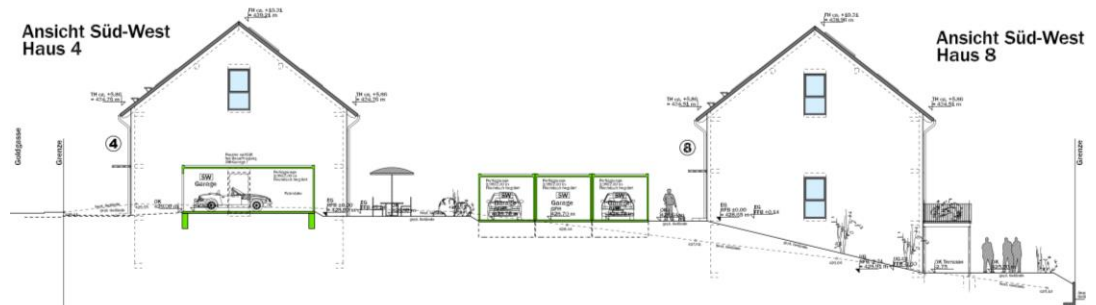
Vorhabenplanung, Neubau von 8 Doppelhaushälften mit Garagen und Stellplätzen, Ansichten Giebel, Süd-West, weisenburger bau, 16.12.2020
